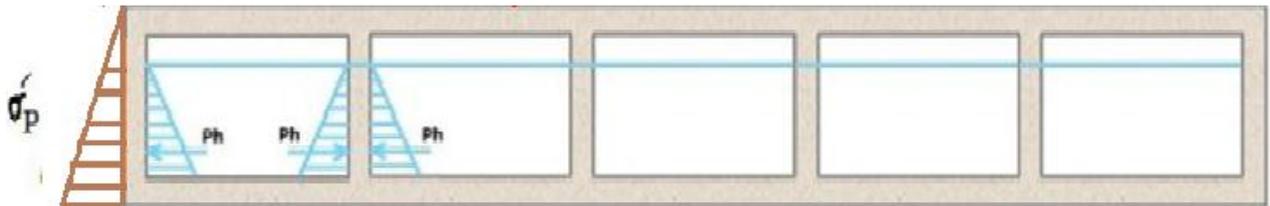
L'action de la poussée des terres sur le dalot.
